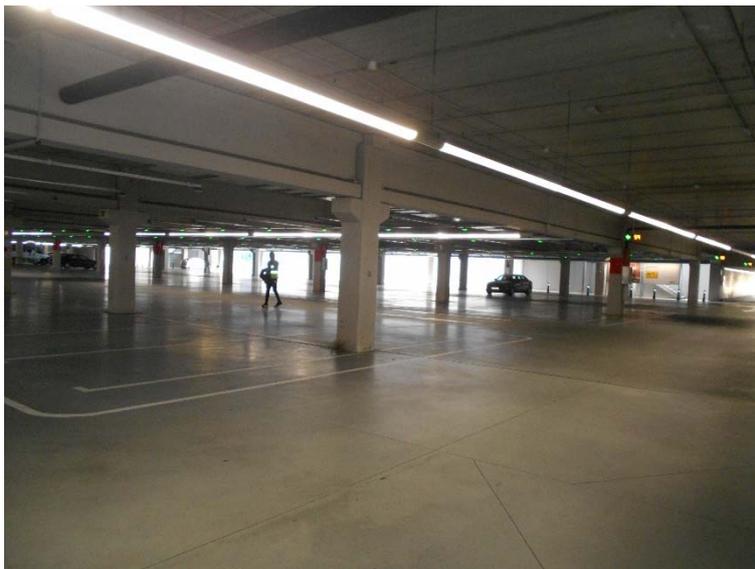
UBICACIÓN DOTs EN ZONA DE PARKING
